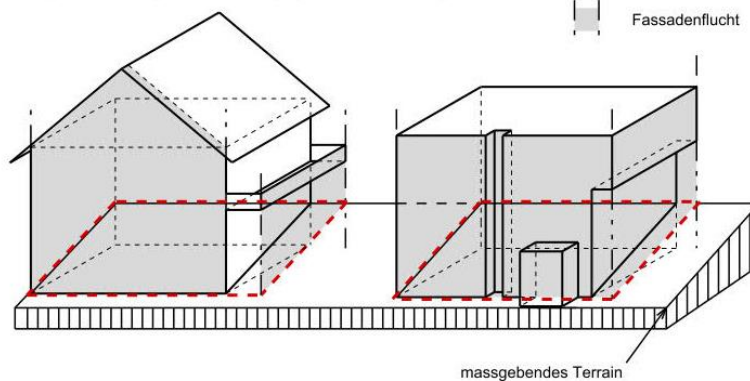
Figur 3.1 bis 3.3 Fassadenflucht und Fassadenlinie, IVHB
